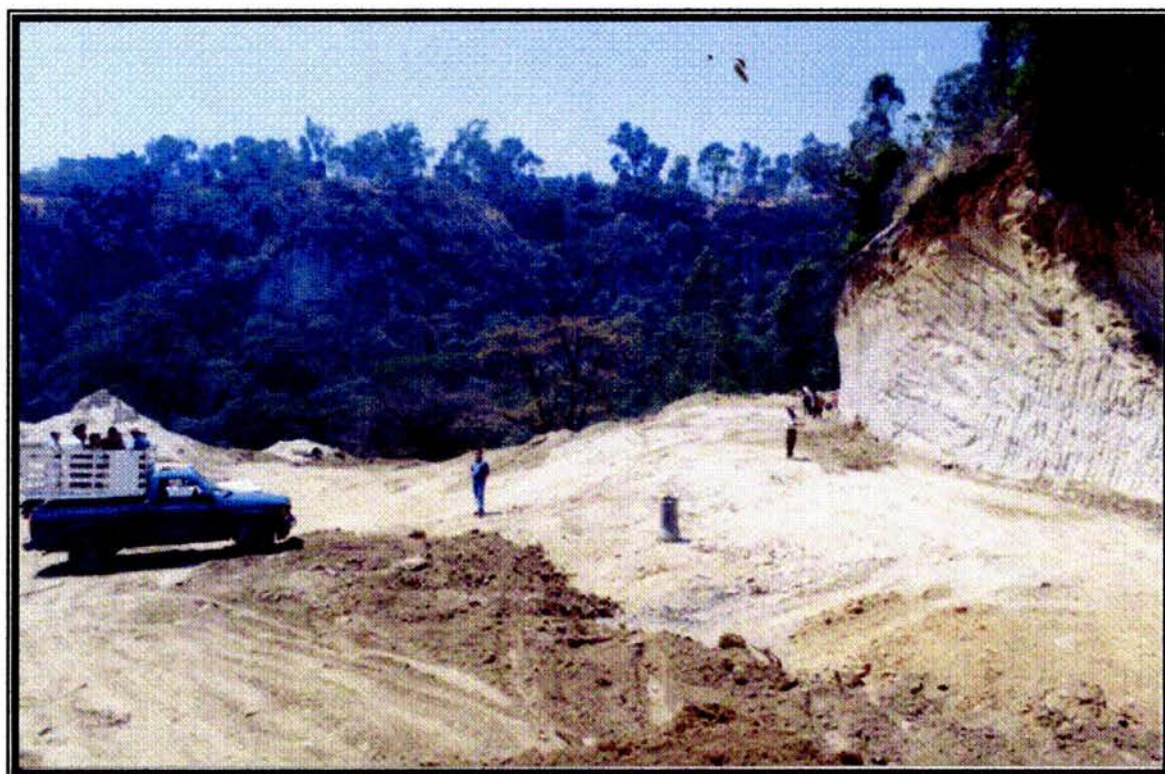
CONSTRUCCIÓN DEL CAMINO DE ACCESO
